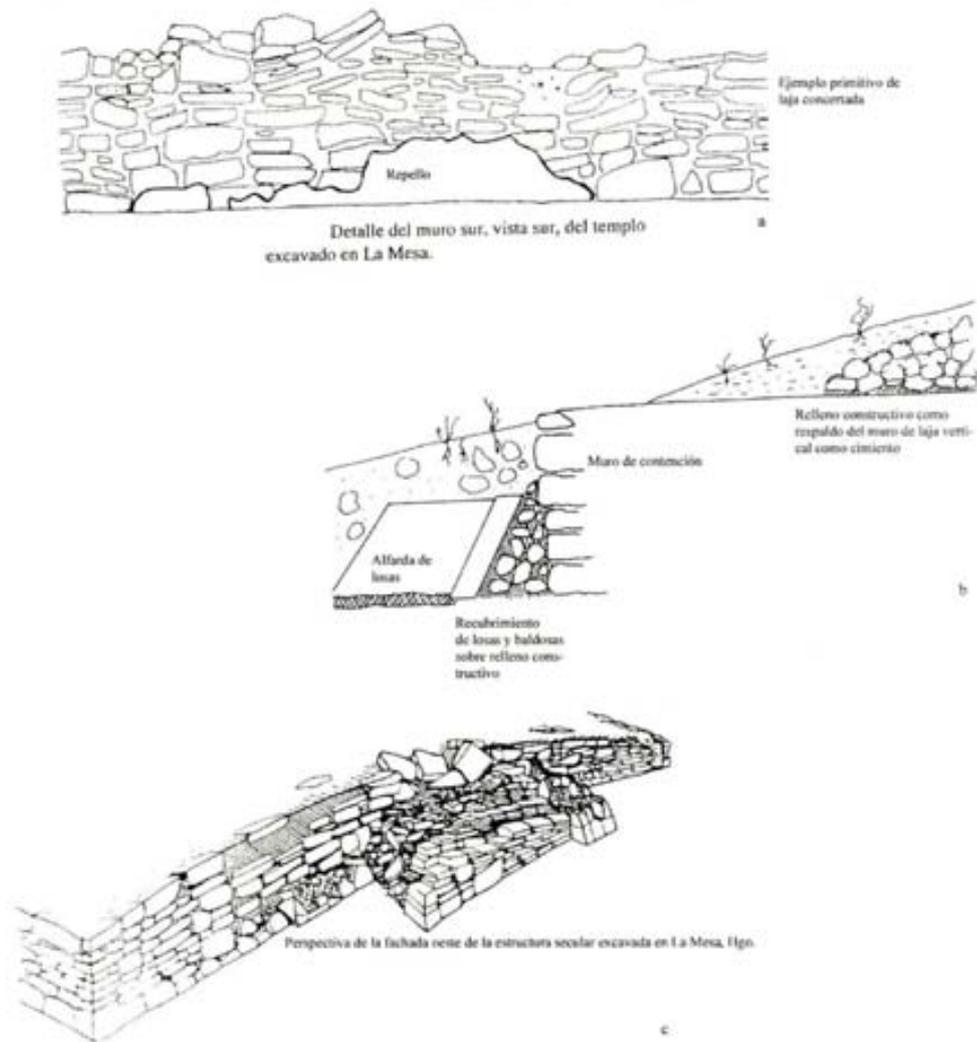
La Mesa Hidalgo: (a) vista sur del muro sur del templo excavado, muestra las características de la mampostería de laja concertada; (b) perfil del recubrimiento sobre el muro oeste de la plataforma para templo; (c) perspectiva de la escalinata y del muro oeste de la plataforma del templo (se pueden apreciar los restos del recubrimiento de baldosas al lado izquierdo de la escalinata) (dibujos del autor).
